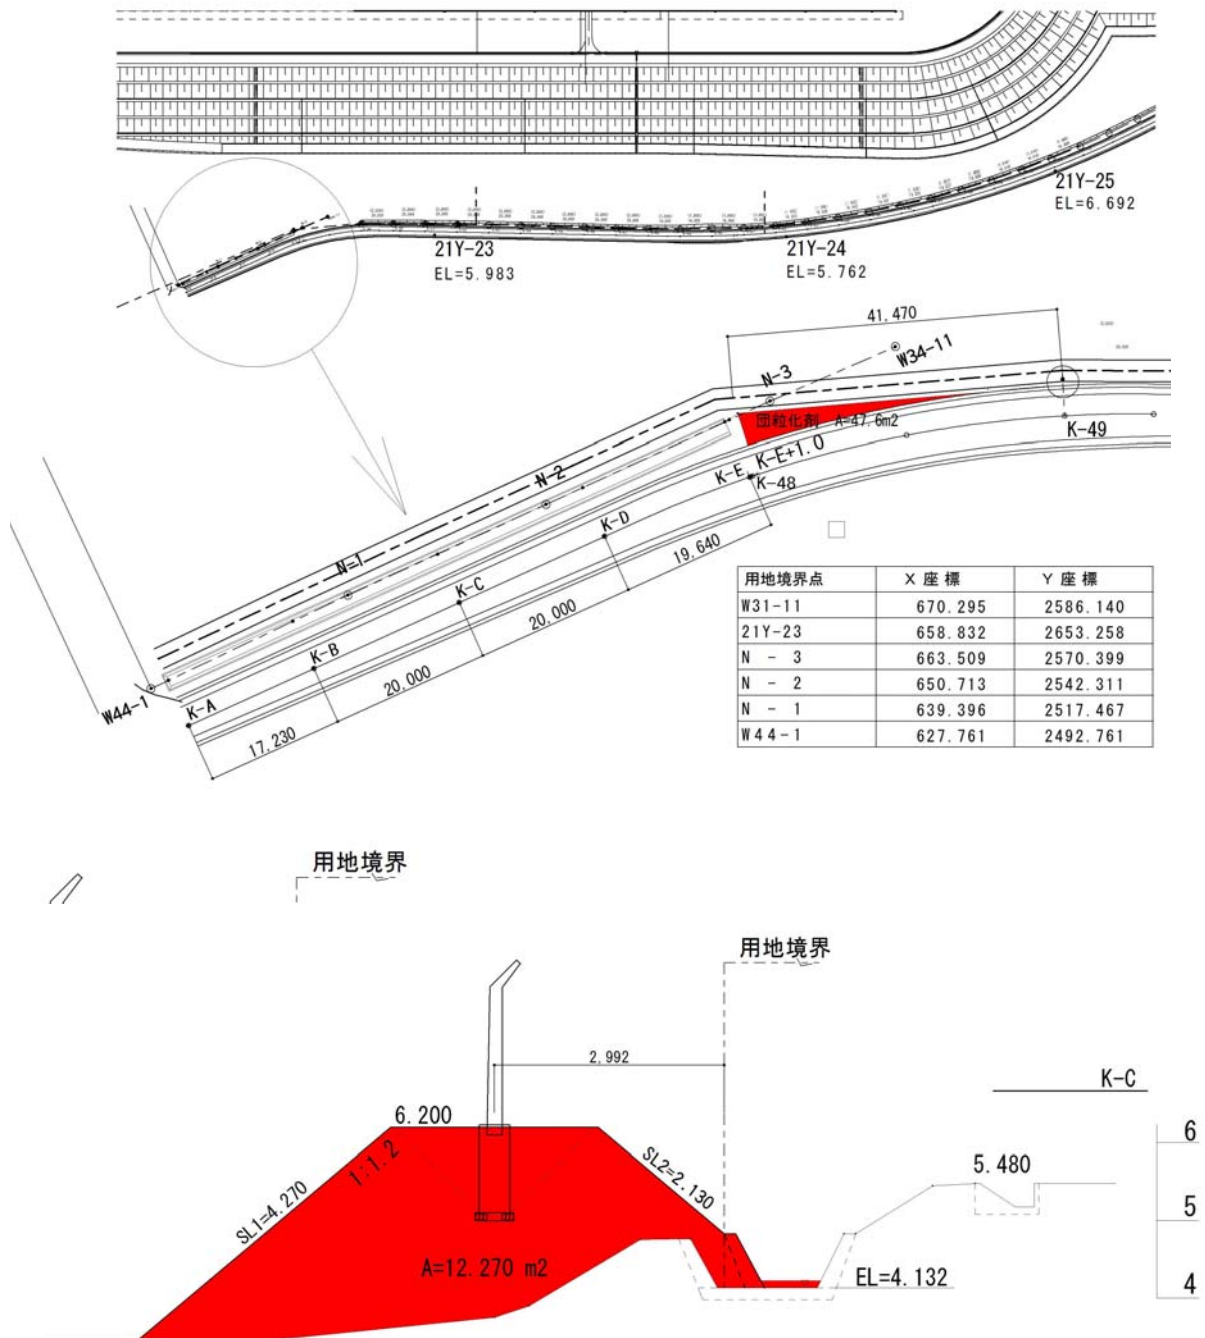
貯留施設の改善状況（上図：平面図、下図：断面図）
